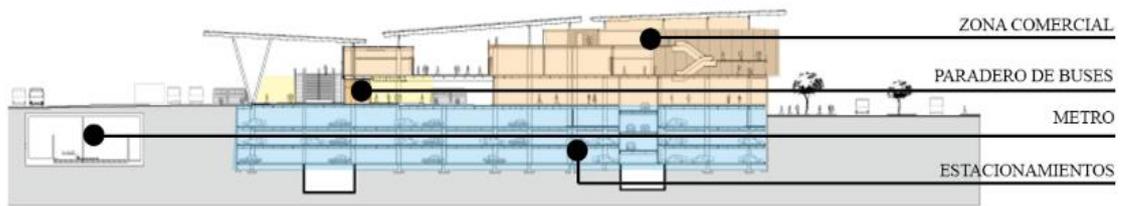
Corte transversal 2 Estación Cuatro Caminos. Fuente: Archdaily, 2018
